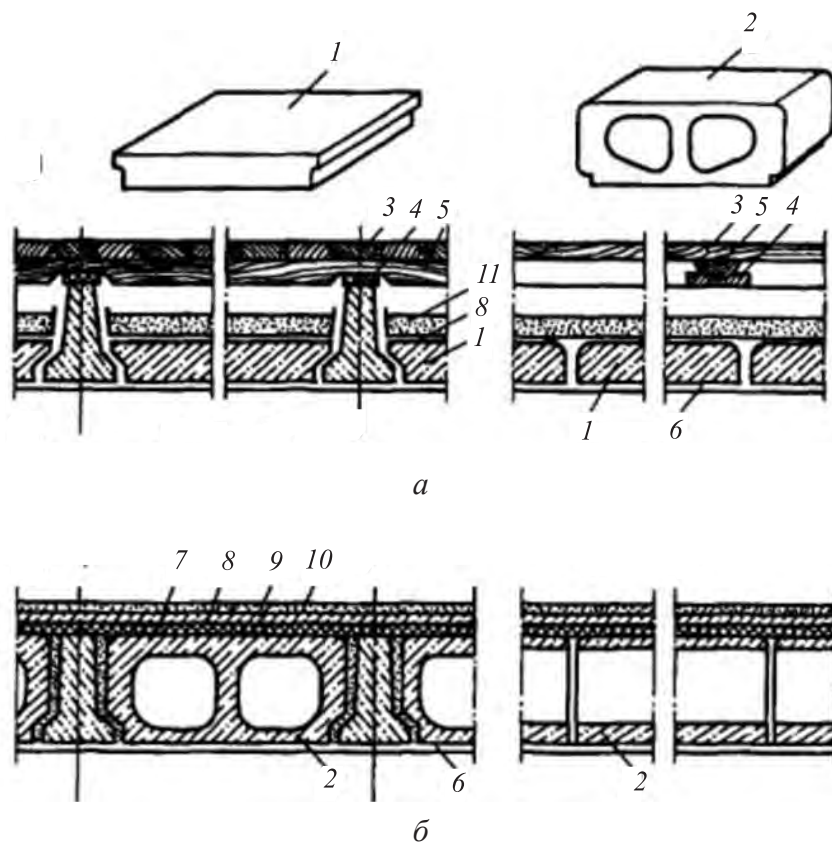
Перекрытия по сборным железобетонным балкам: *а* — накатом из сплошных плит; *б* — заполнением двухпустотными вкладышами: 1 — гипсобетонная плита; 2 — легковесный вкладыш; 3 — дощатый пол; 4 — звукоизоляционная прокладка; 5 — лага; 6 — затирка; 7 — оргалит; 8 — толь; 9 — легкий бетон; 10 — чистый пол; 11 — засыпка (из шлака)
